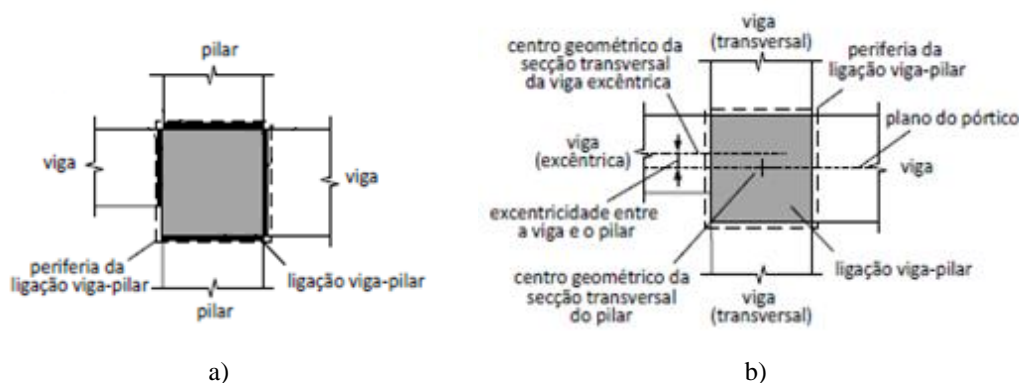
a) Vista lateral de uma ligação viga-pilar com vigas de secção transversal de diferentes alturas e b) Vista em planta de uma ligação viga-pilar excêntrica (Costa, 2013)
